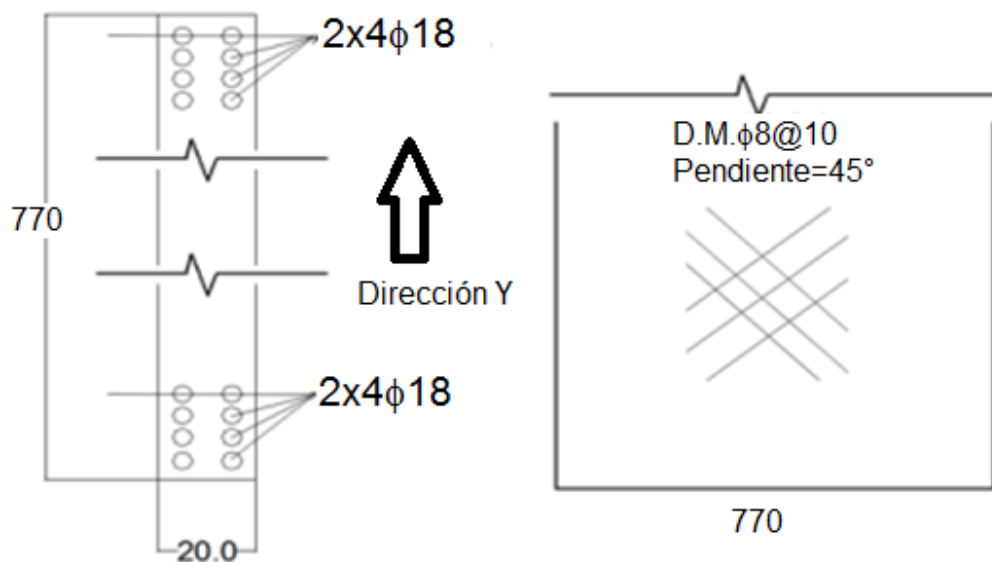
Detalle de armaduras del elemento B4-4, corte transversal y elevación
